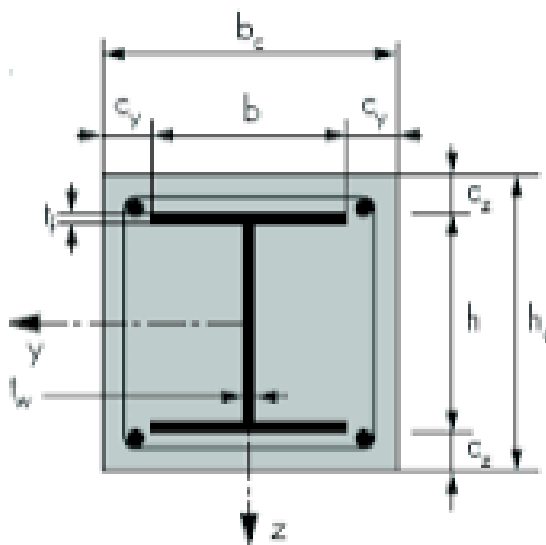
Sections transversale de poteau entièrement enrobé.
